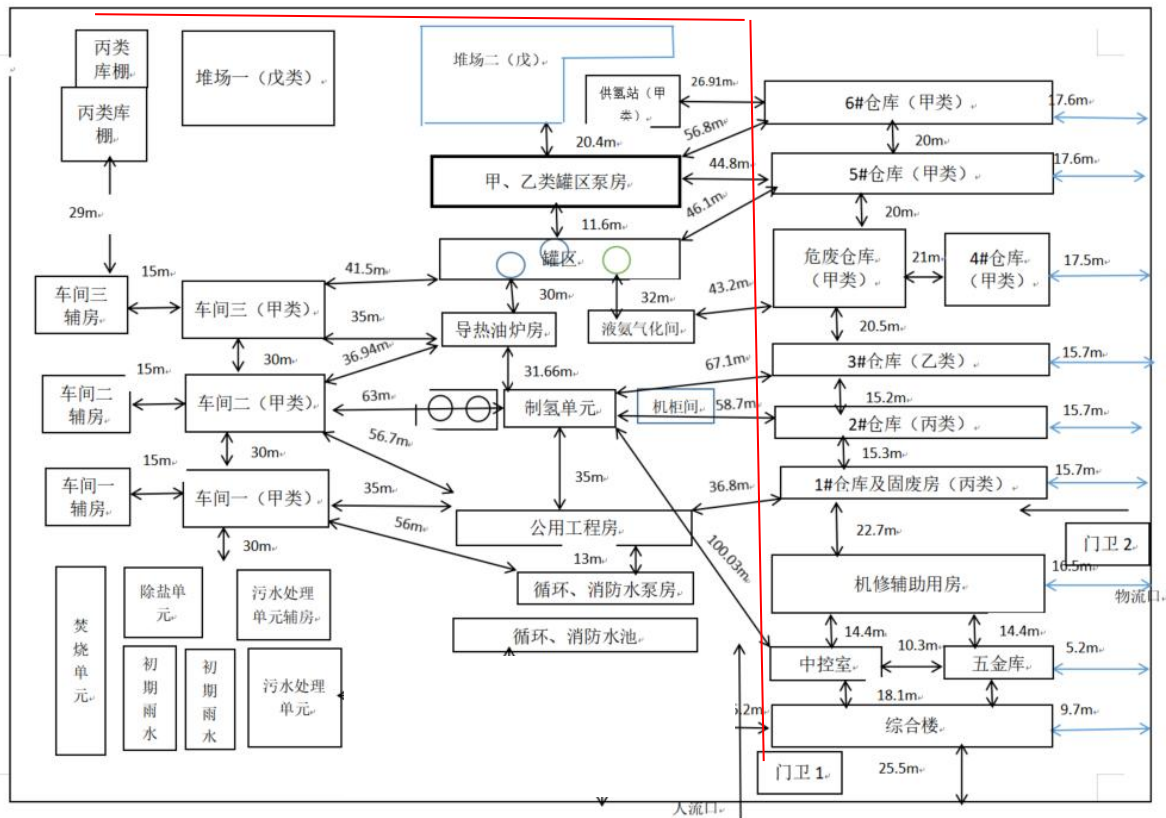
总平面布置示意图（红色线条为公司原料、产品运输道路）
